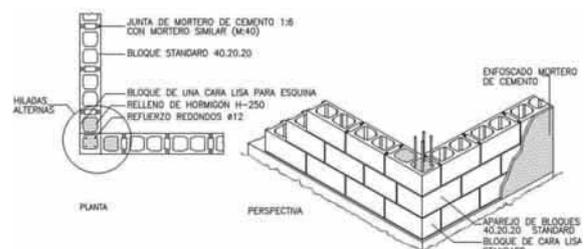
Esquina de fábrica con pilastra (planta y perspectiva).
